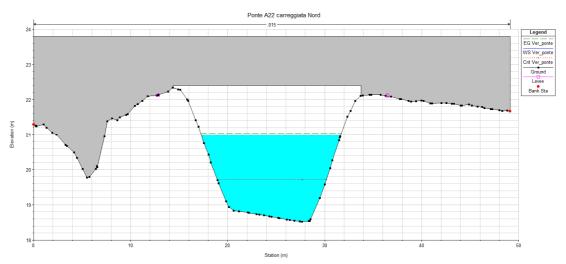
Sezione trasversale della carreggiata Nord del ponte dell'Autostrada del Brennero sul Canale Acque Alte - stato di fatto
